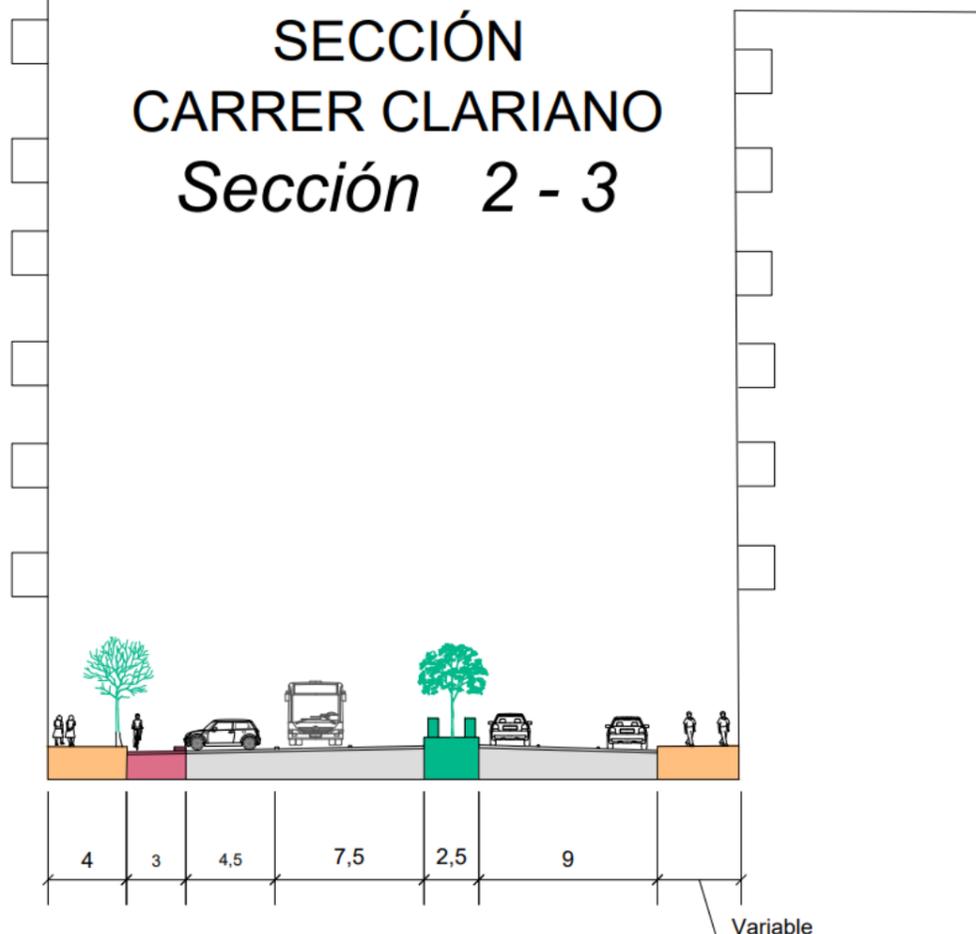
Sección tipo calle Clariano. Fuente: Elaboración propia.
